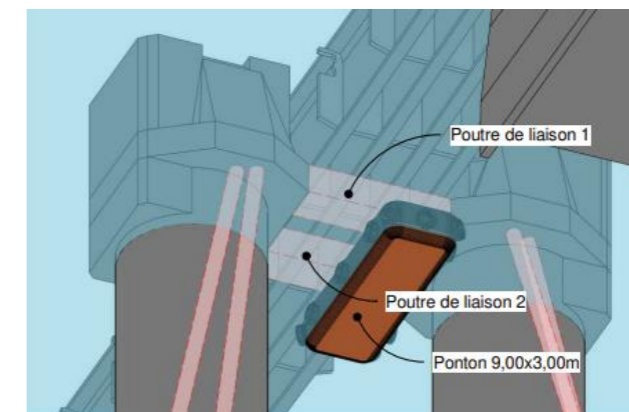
Positionnement des pontons pour le démontage des Ducs d'Albe et poutres de liaison
